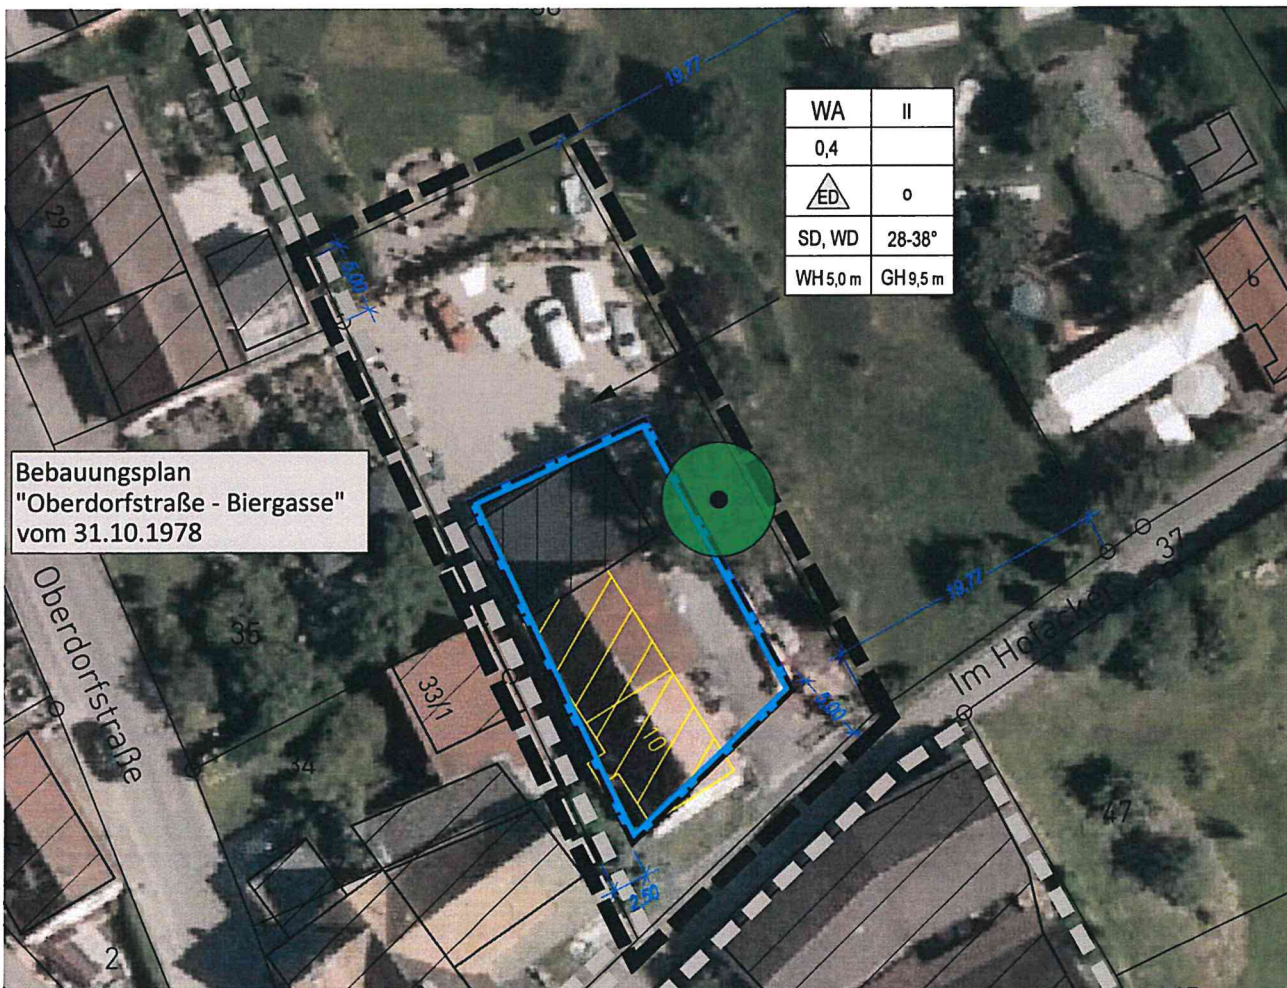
Ausschnitt Luftbild mit geplanter Bebauung
